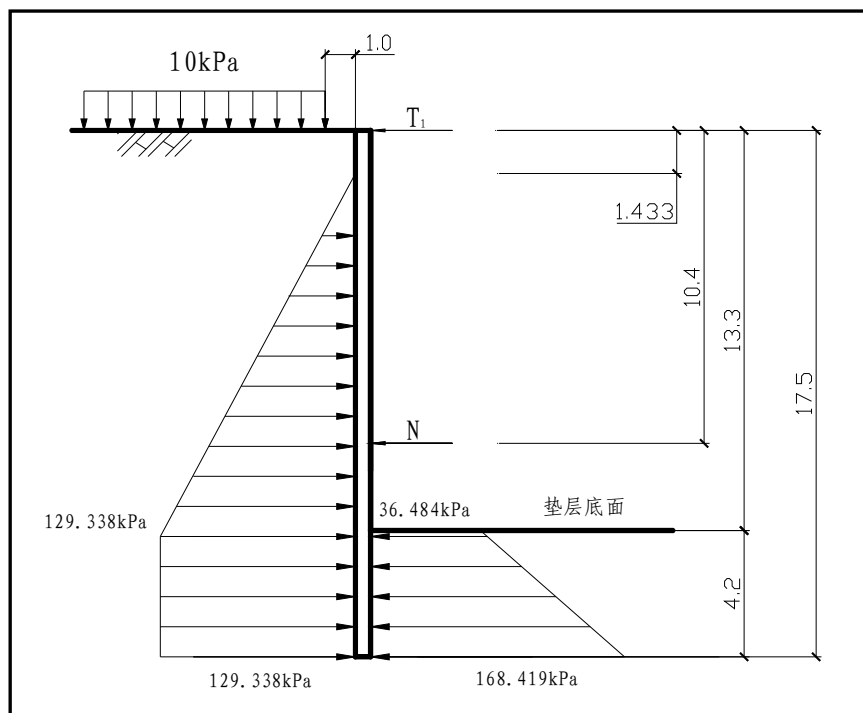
增设临时支撑的力学计算简图（尺寸单位：m）
